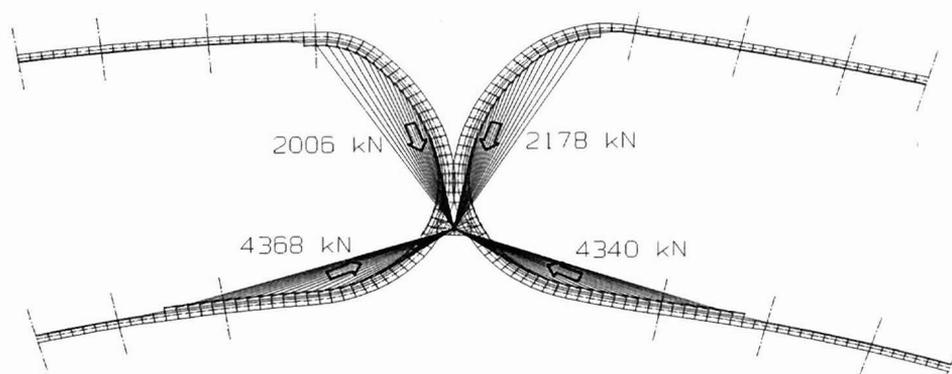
Equilibrio en planta de las fuerzas en cables para el estado de carga permanente.
